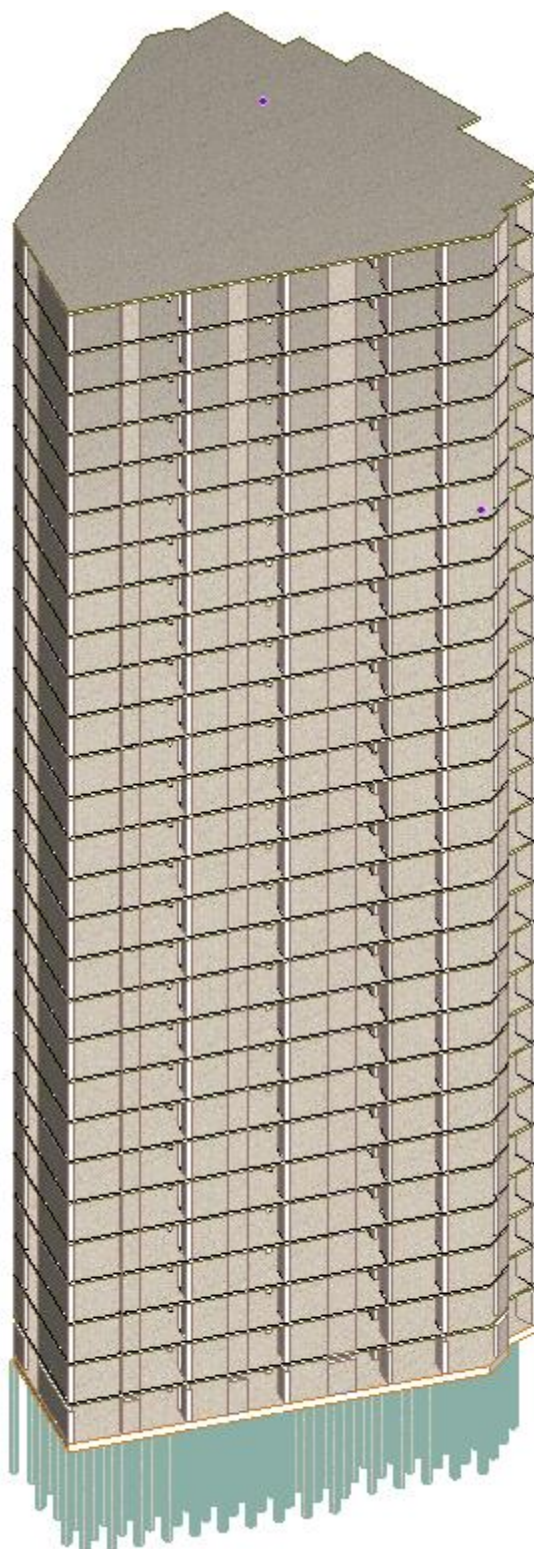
Розрахункова схема будівлі у ПК «САПФІР»
